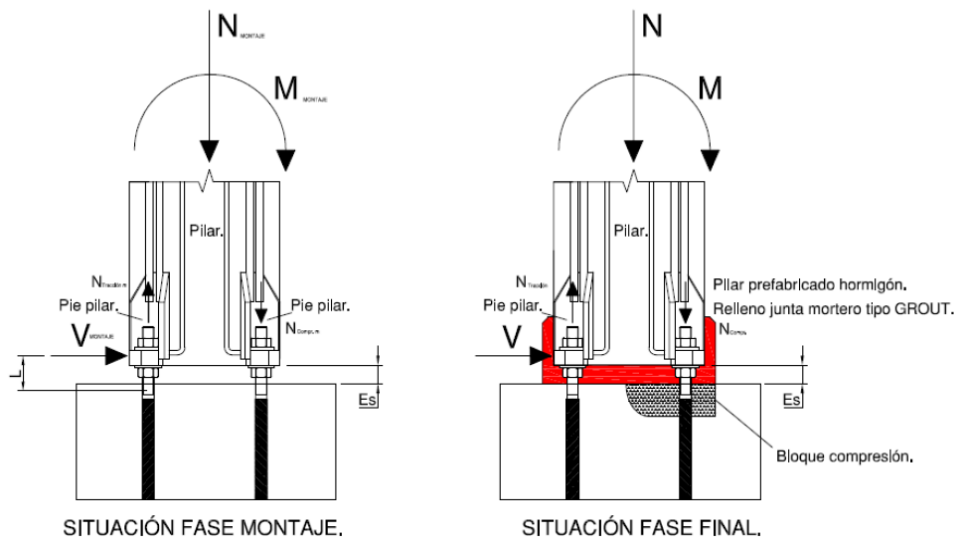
Acciones sobre el pilar en situación de montaje y final
